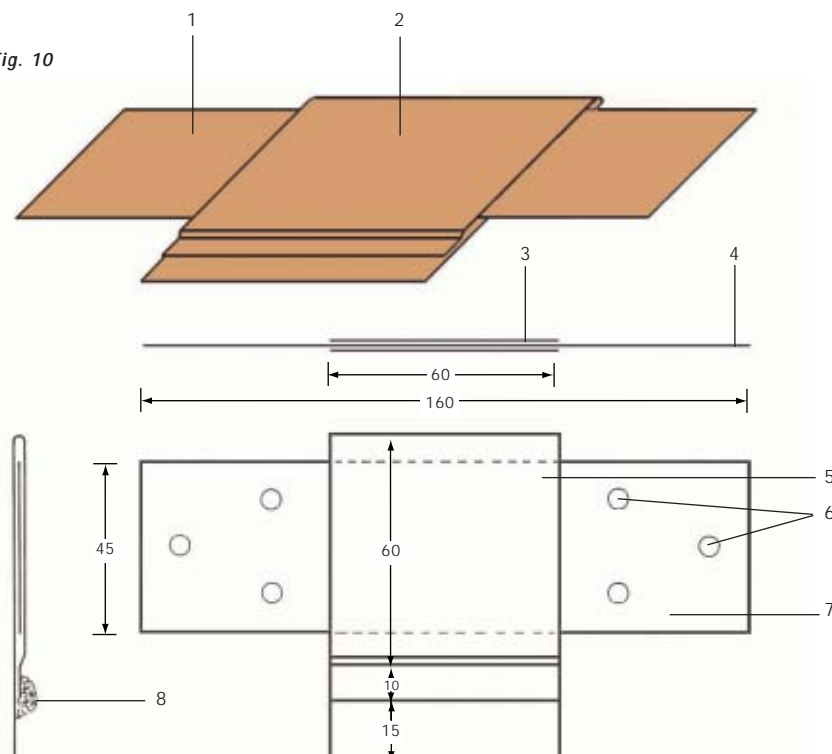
Detalhe de junta soldada e plaqueta deslizante.
